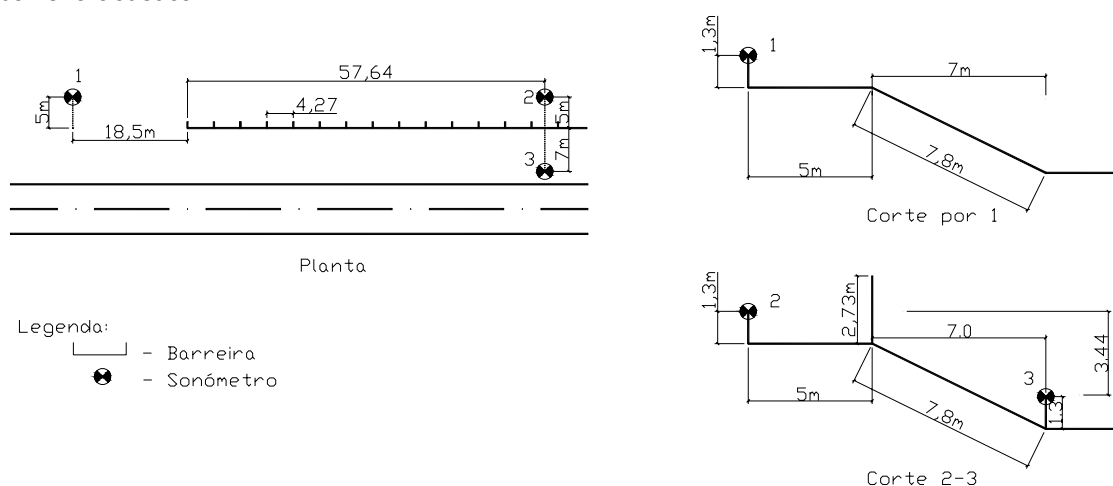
Localização dos equipamentos de medição em planta e em corte no caso de estudo 1.
